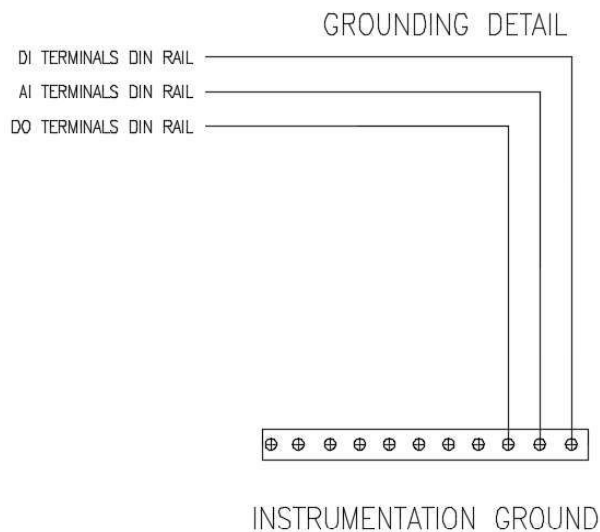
Detalle del sistema de puesta a tierra de instrumentación.
